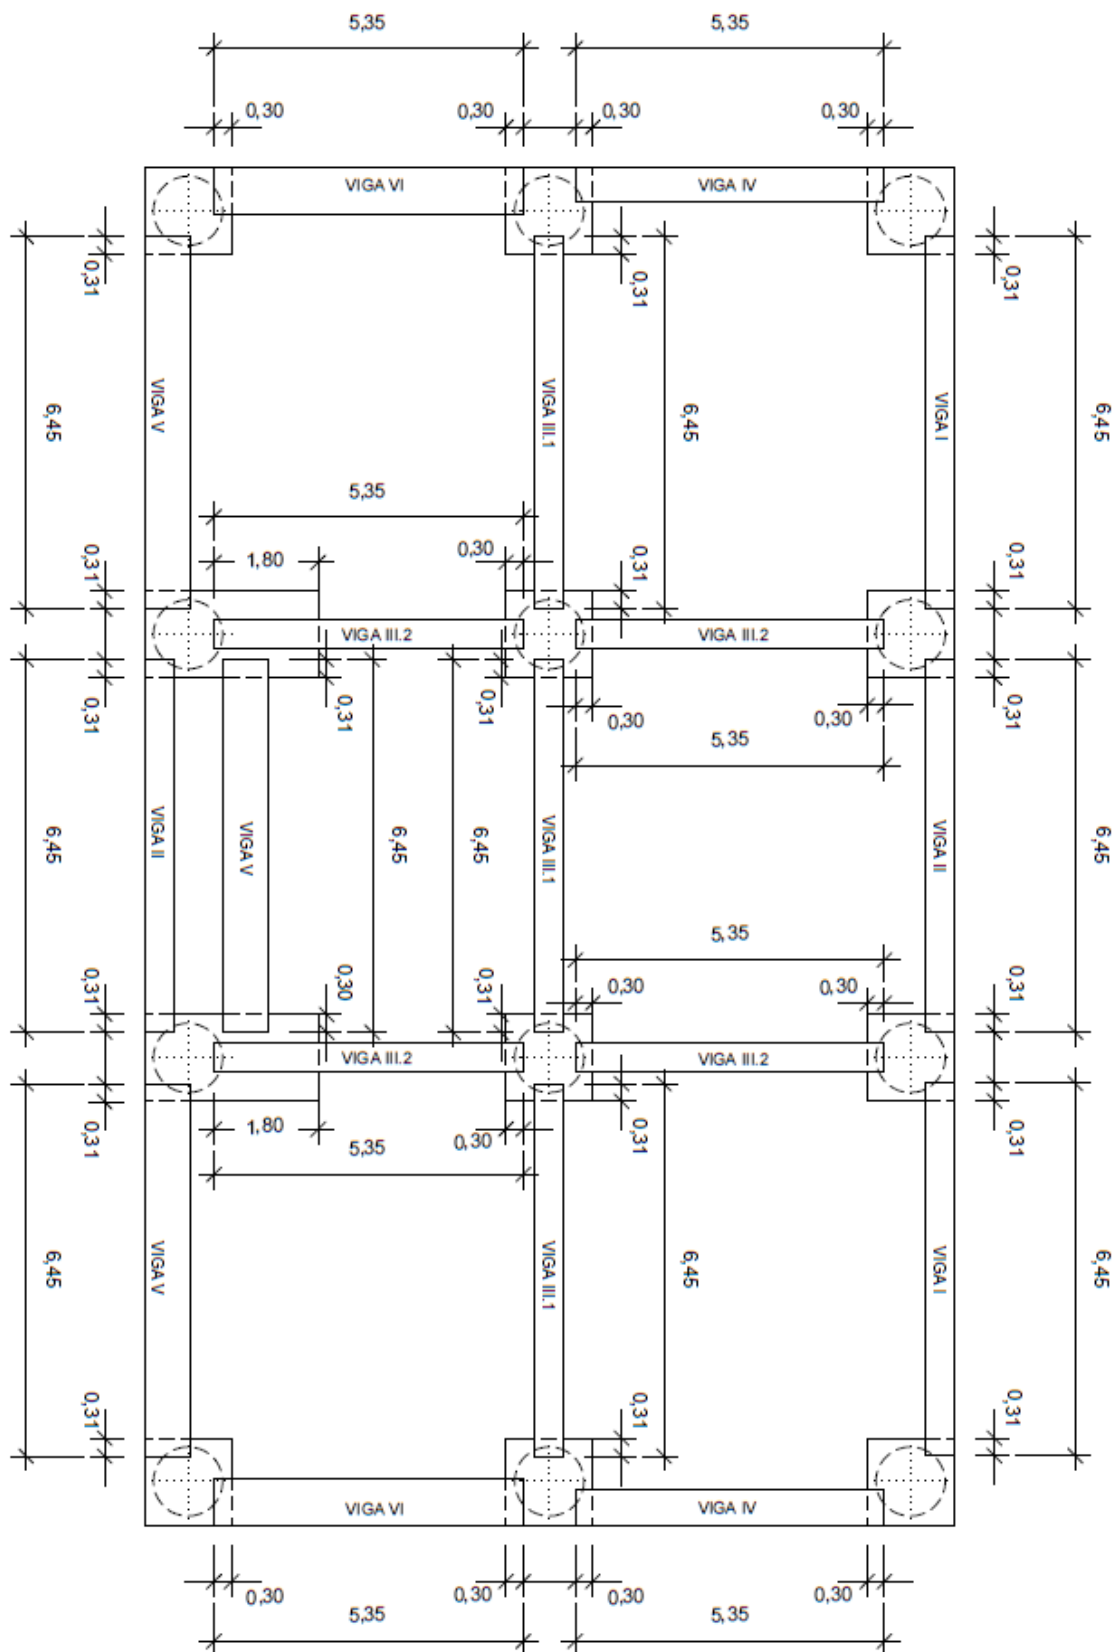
Disposición de las vigas prefabricadas sobre capiteles en la plataforma de atraque.
